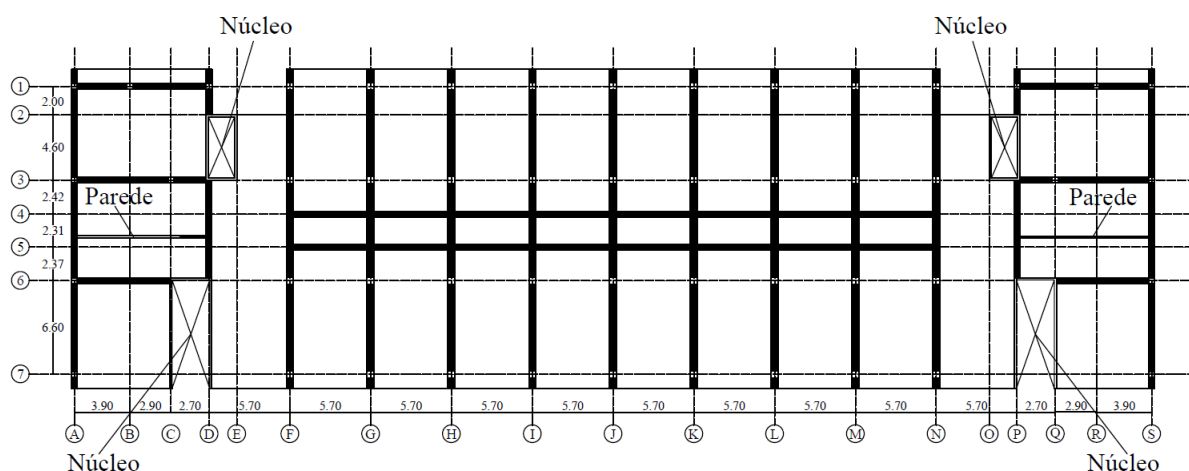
Pórticos (a cheio), paredes e núcleos de betão armado do primeiro piso, comuns aos edifícios em betão armado e CLT
